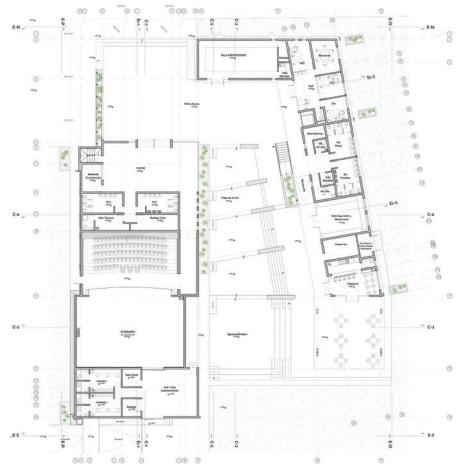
Planta baja de Centro Cultural Alto Hospicio, Archdaily.
